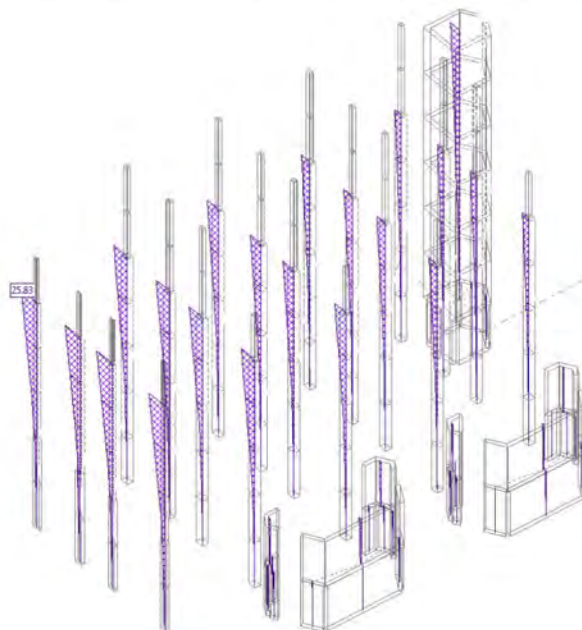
spostamenti globali in direzione trasversale Y (in mm) zona 4
